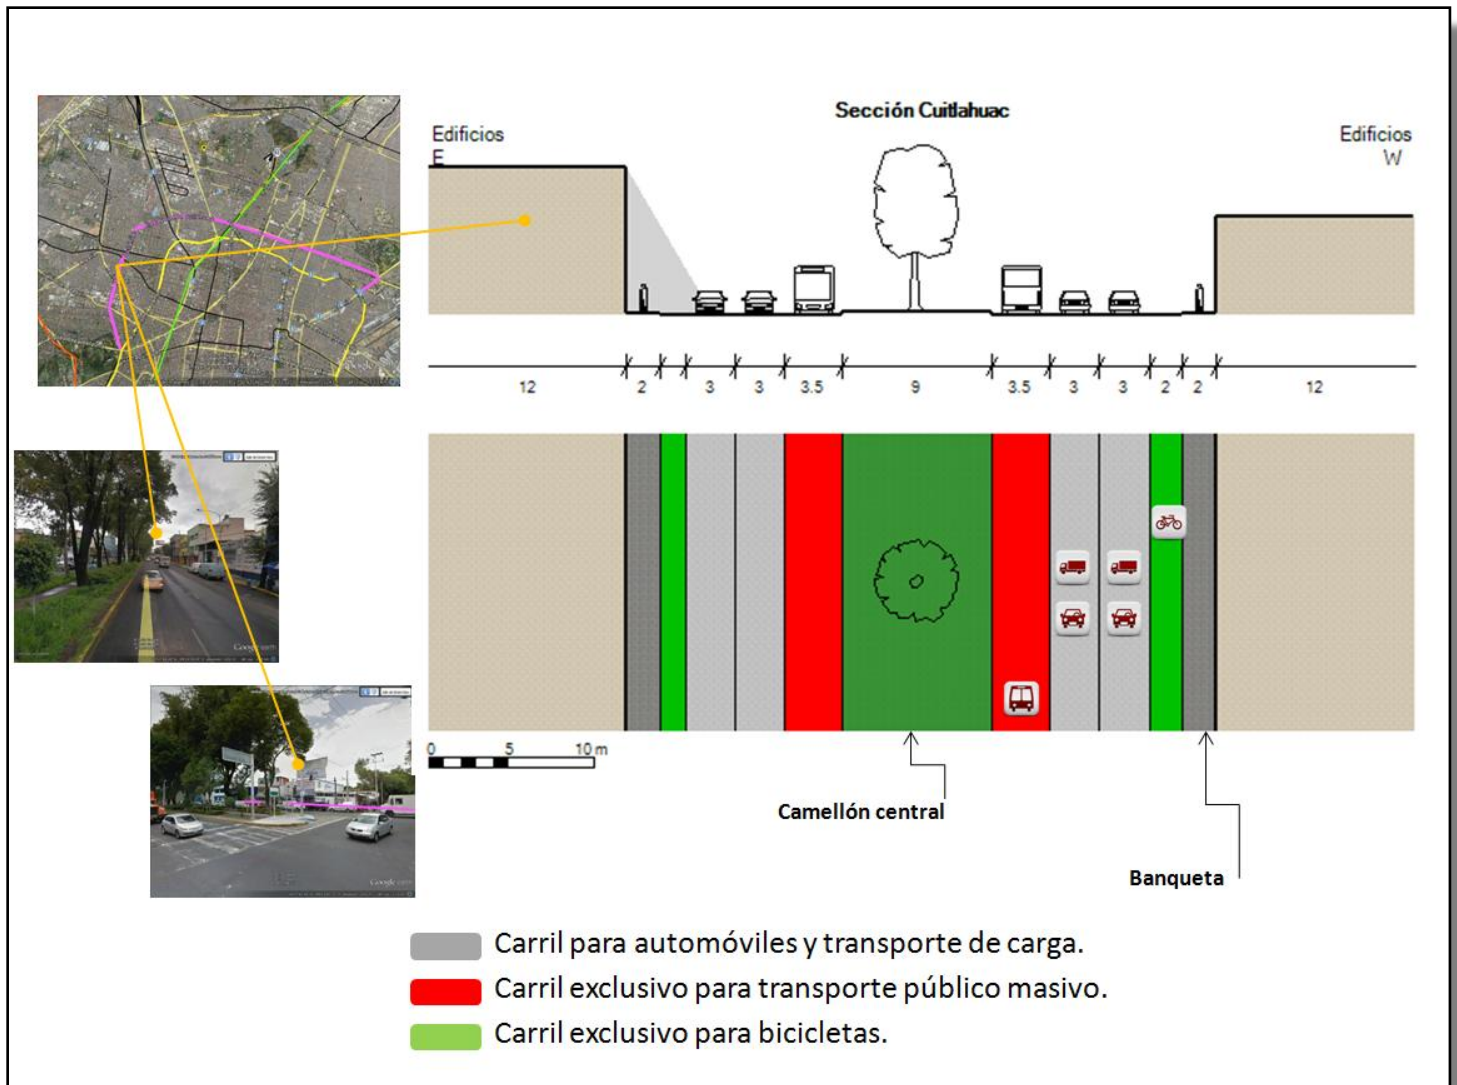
Sección tipo, localizada en la Avenida Cuitláhuac y Calle Egipto, Colonia Nueva Santa María, Delegación Miguel Hidalgo, D.F. Ancho de la sección: 30 m.; banquetas de 2 m. de ancho; a lo largo de 1 kilómetro de vía se proponen cuatro estaciones de bicicletas a cada 250 m.²⁶⁸
